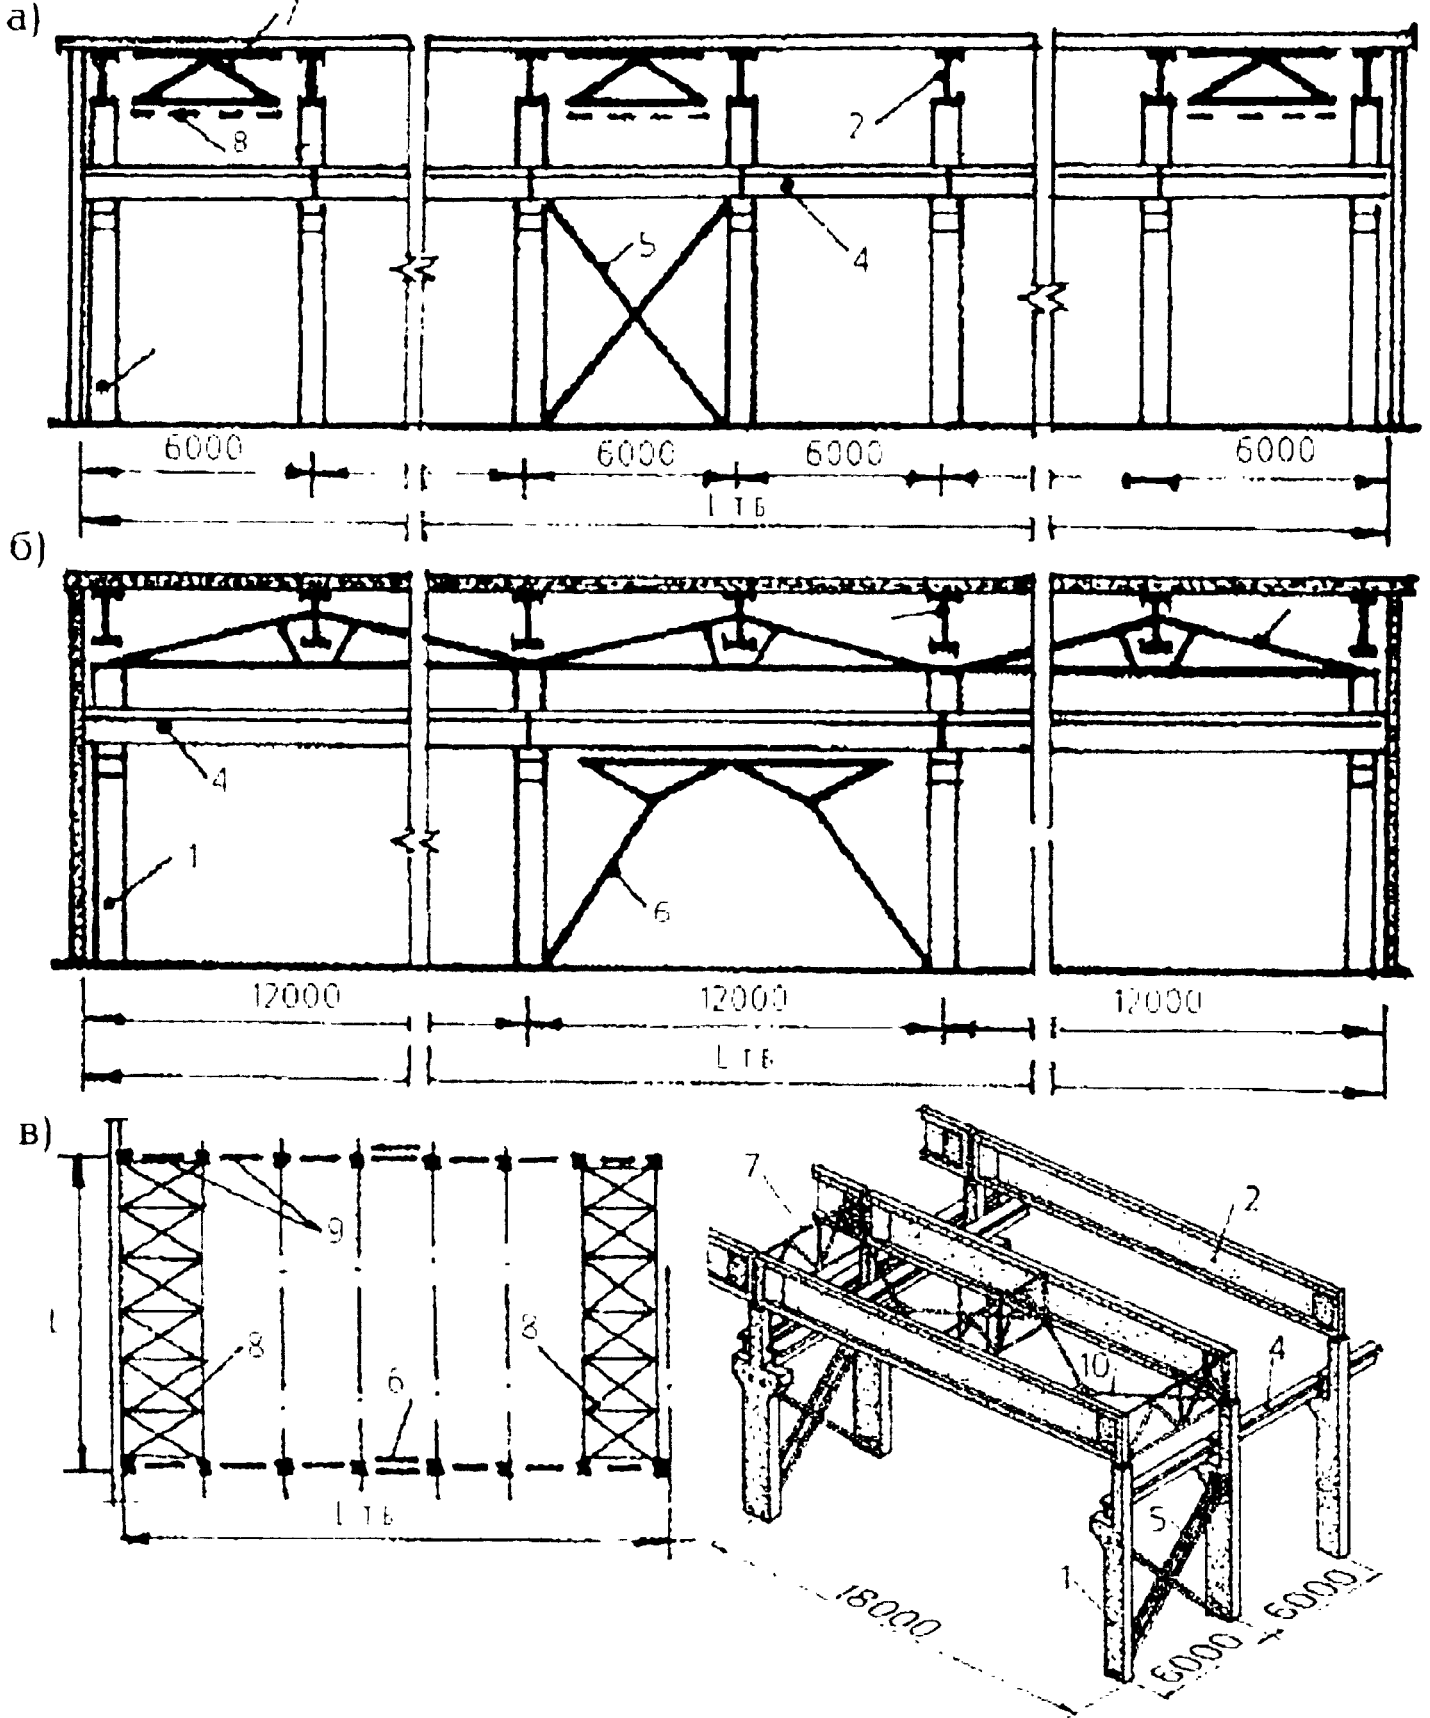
Одноэтажный железобетонный каркас промышленного здания. Связи: а - размещение вертикальных связей в зданиях с плоскими покрытиями (без подстропильных конструкций); б - размещение вертикальных связей в зданиях с подстропильными конструкциями; в - размещение горизонтальных связей в пределах температурного блока; 1 - колонна; 2 - стропильная конструкция; 3 - подстропильная конструкция; 4 - подкрановая балка; 5 - крестовые вертикальные связи; 6 - порталные вертикальные связи; 7 - связевые вертикальные фермы; 8 - ветровые горизонтальные фермы; 9 - распорки; 10 - горизонтальные крестовые связи
